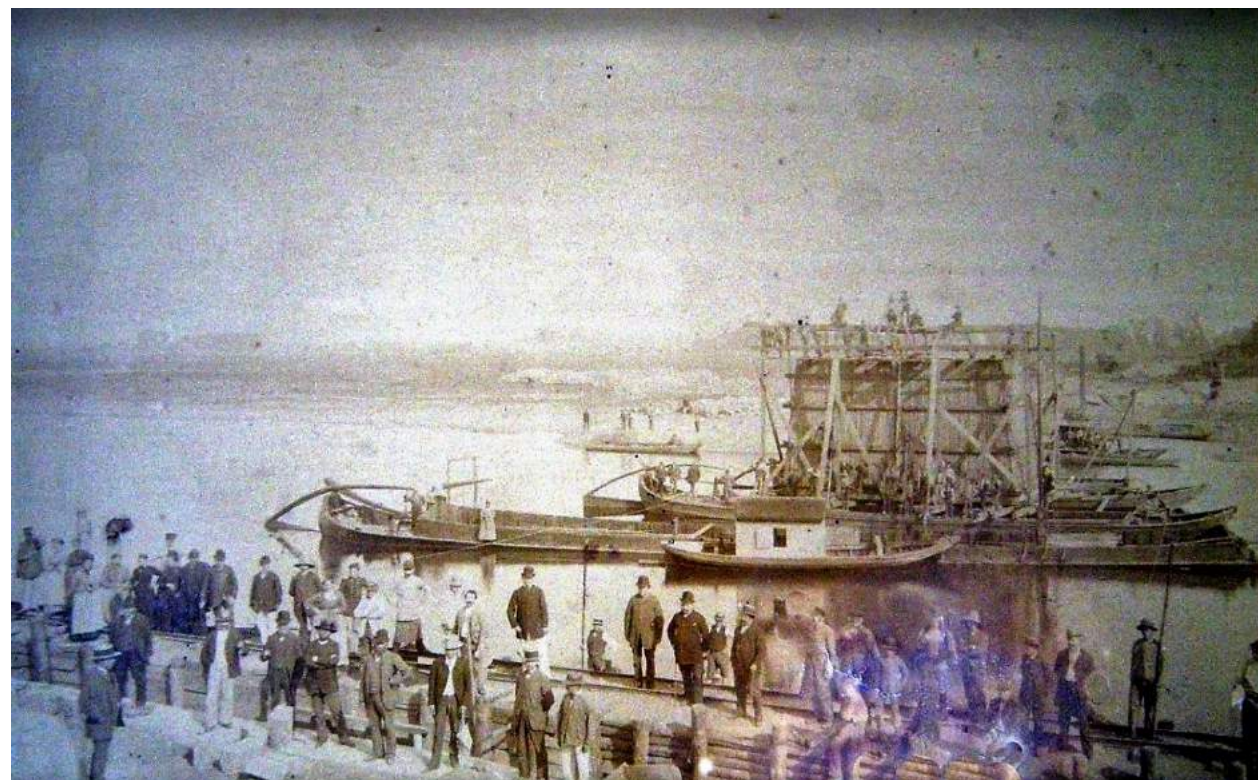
aanleg pijlers eerste stenen Maasbrug omstreeks 1889
